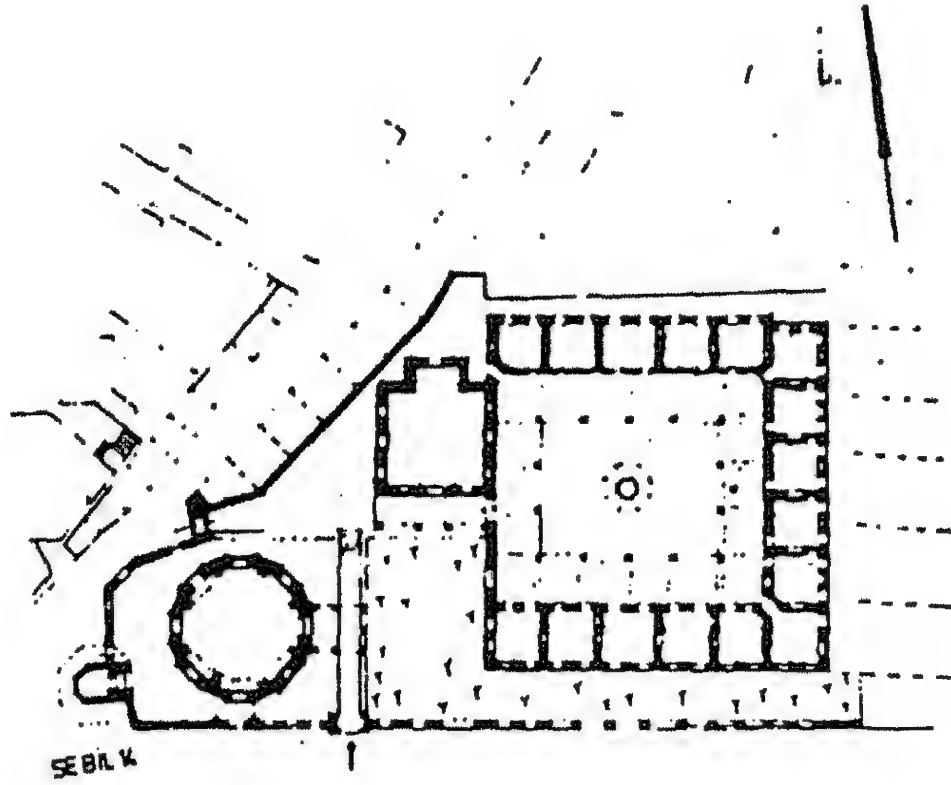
مسقط أفقي لمسجد الوالده الجديد (ينى جامع) في إستانبول (عن :
